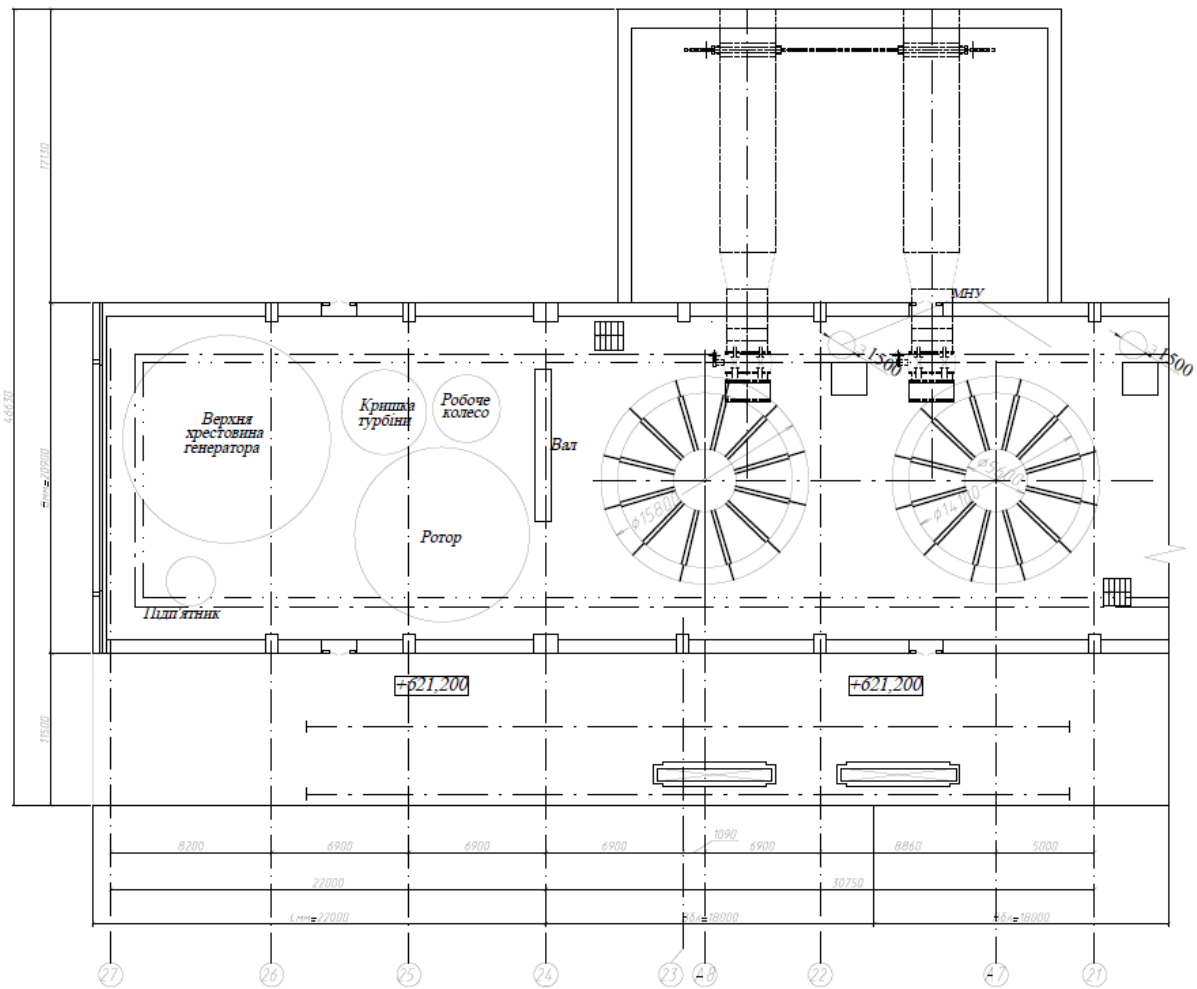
План будівлі ГЕС пригребельного типу на скельній основі
